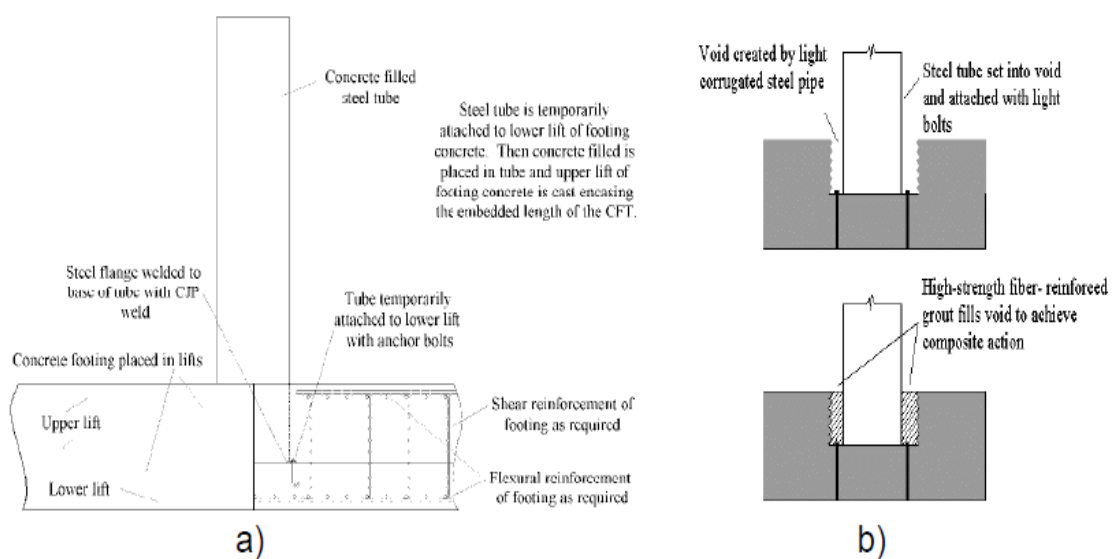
Coppia di connessioni ibride tra fondazione e colonna C.F.T.
